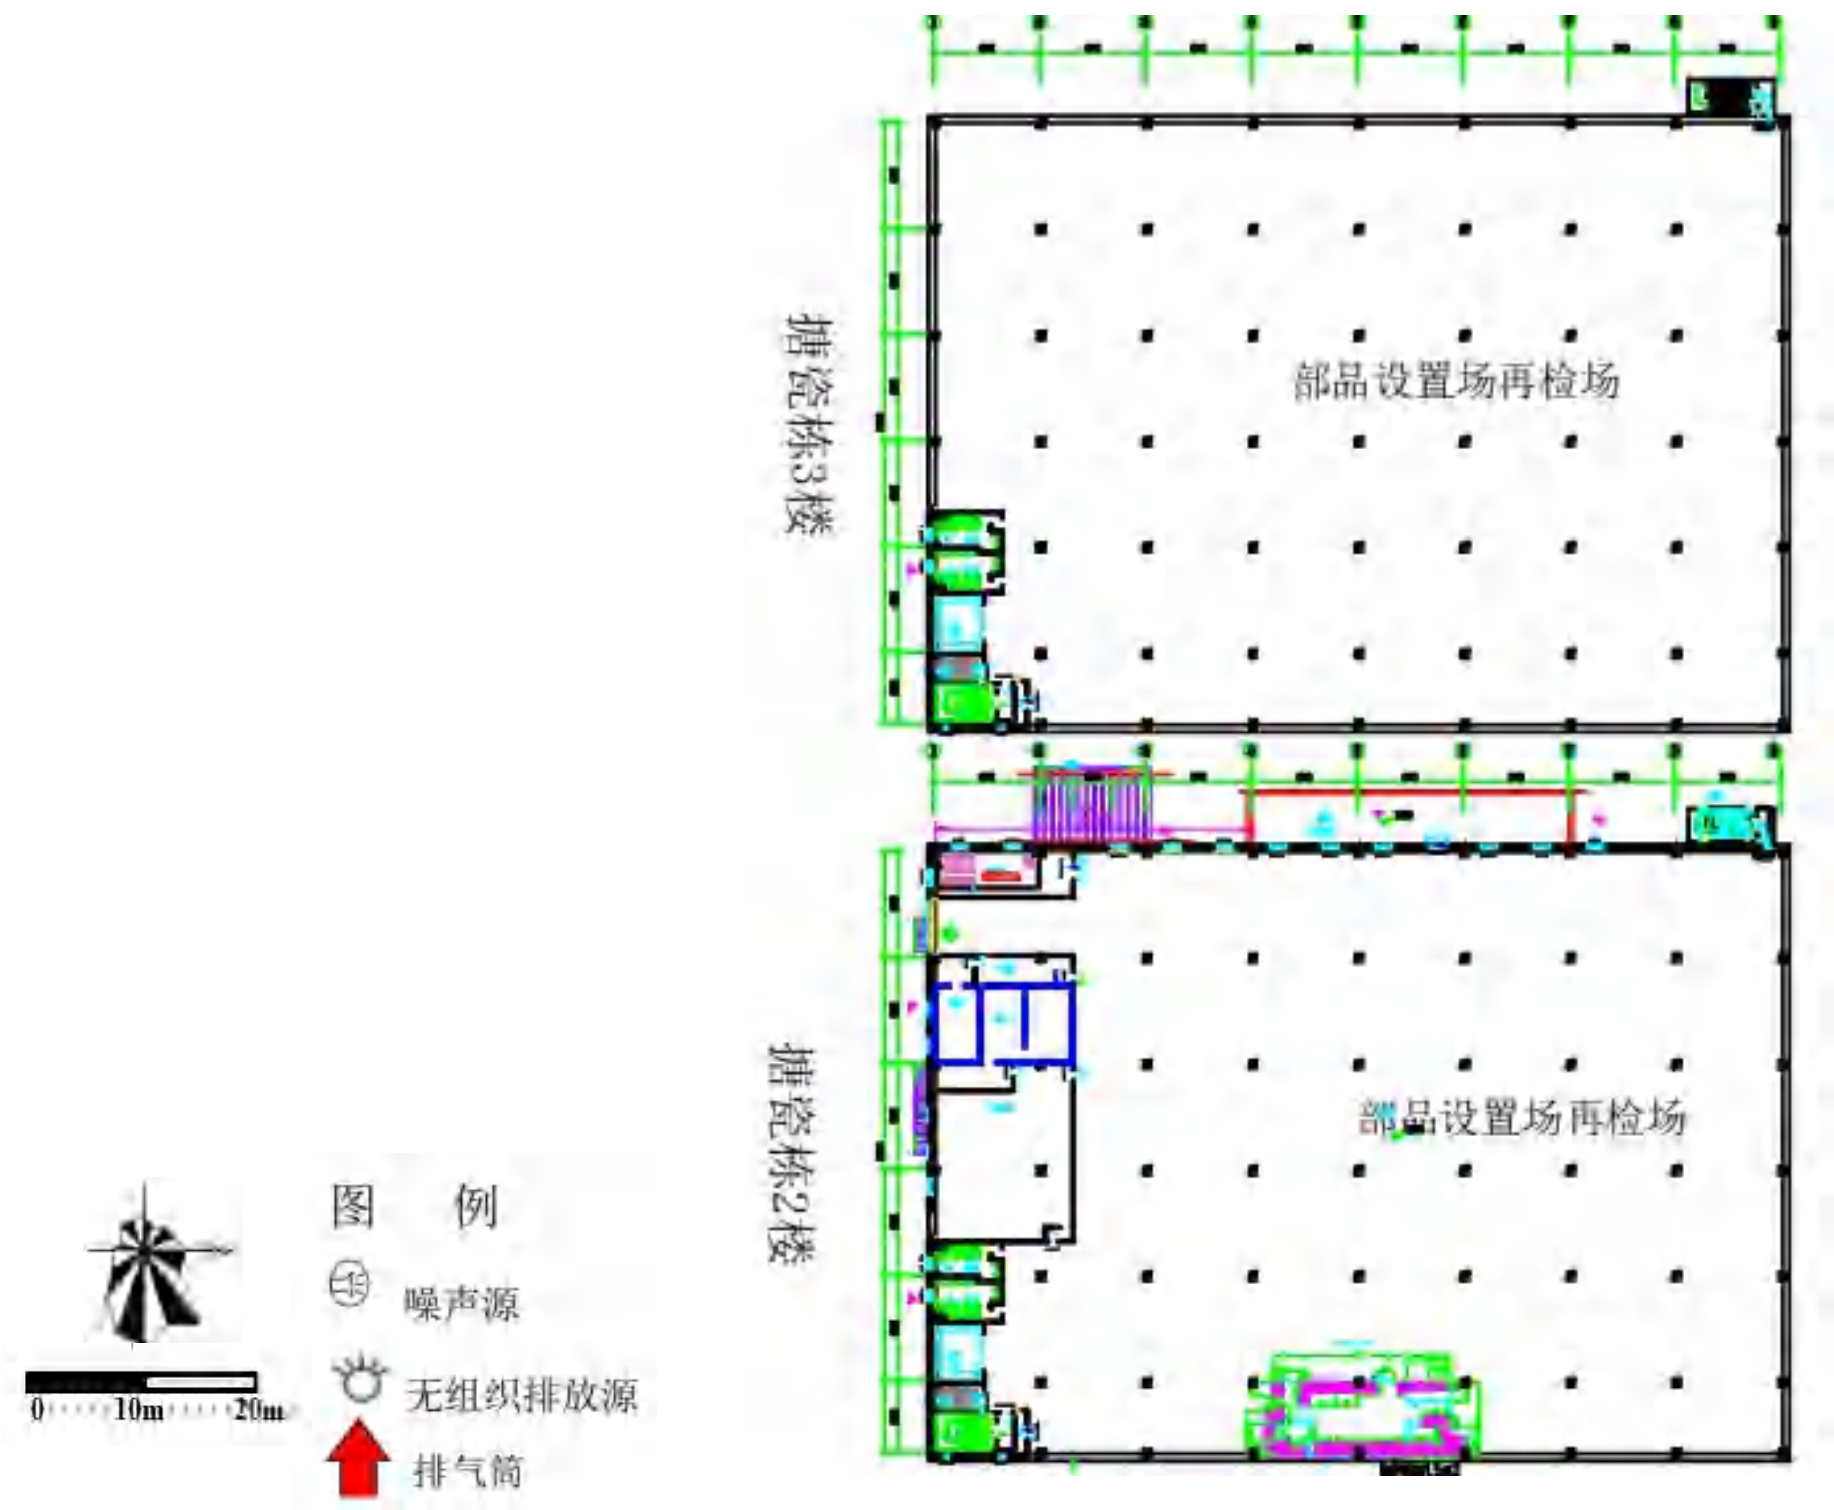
(2) 塘瓷浴缸西栋 2F-3F 平面布置图
